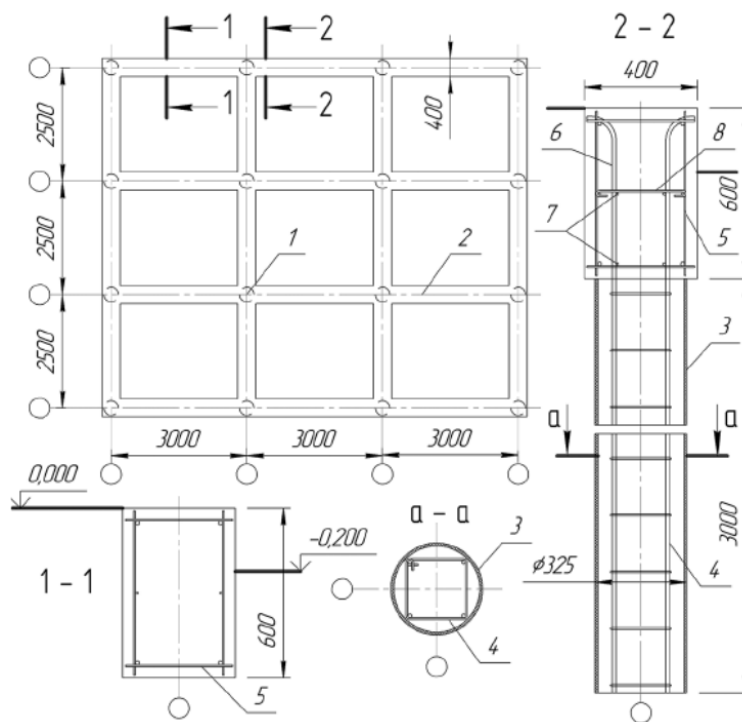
Армирование ростверка и буровых свай: 1 – свая; 2 – ростверк; 3 – э/с труба; 4 – объемный каркас сваи; 5 – объемный каркас ростверка; 6 – арматурные выпуски каркаса армирования сваи; 7 – дополнительные продольные стержни; 8 – шпилька
